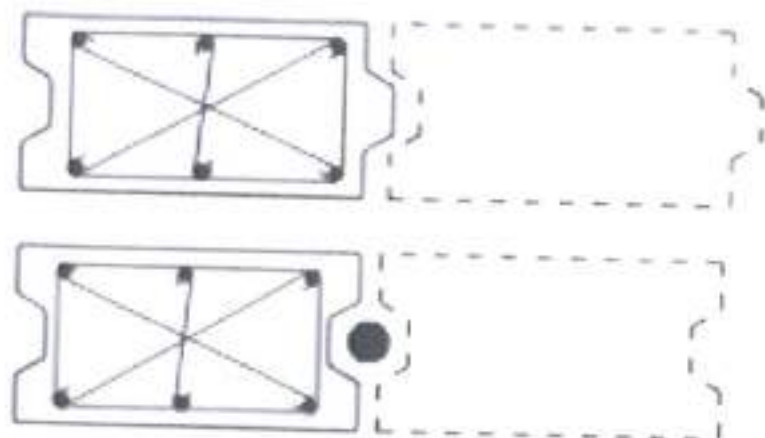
Exemple de palplanse din beton armat sau precomprimat si de tipuri de îmbinari
